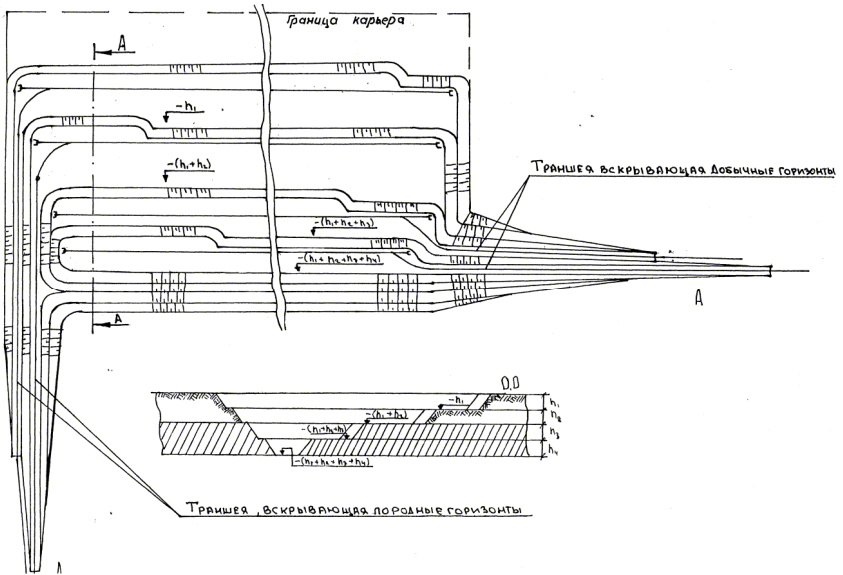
Схема вскрытия внешними групповыми траншеями
